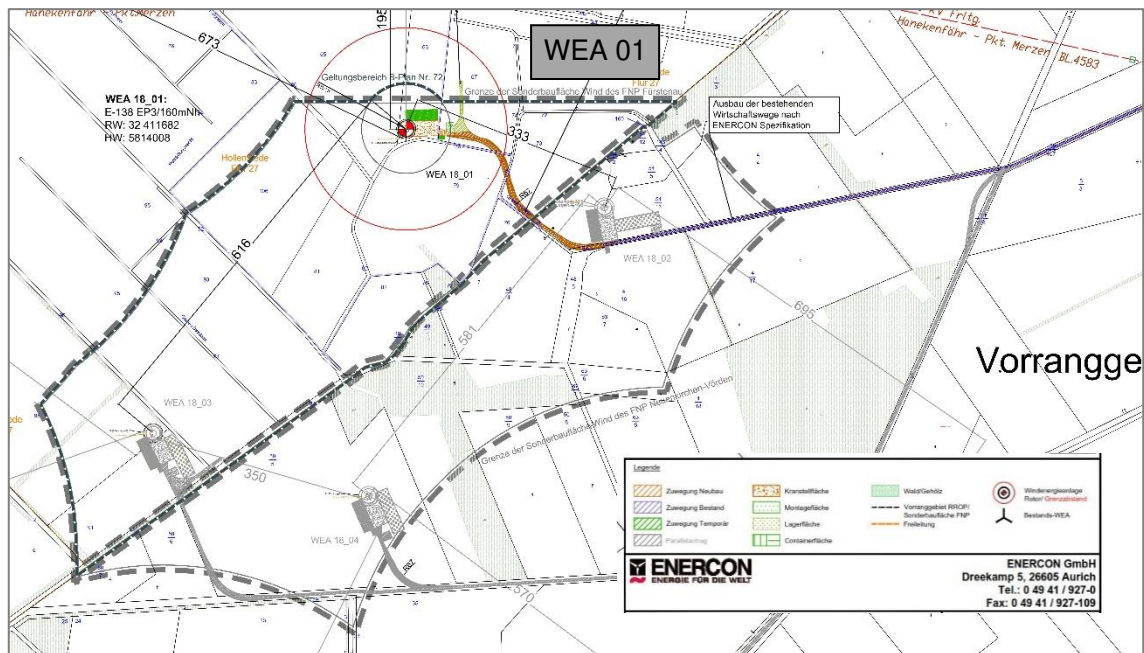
Auszug aus Lageplan für geplanten Windpark (Quelle: Enercon)
